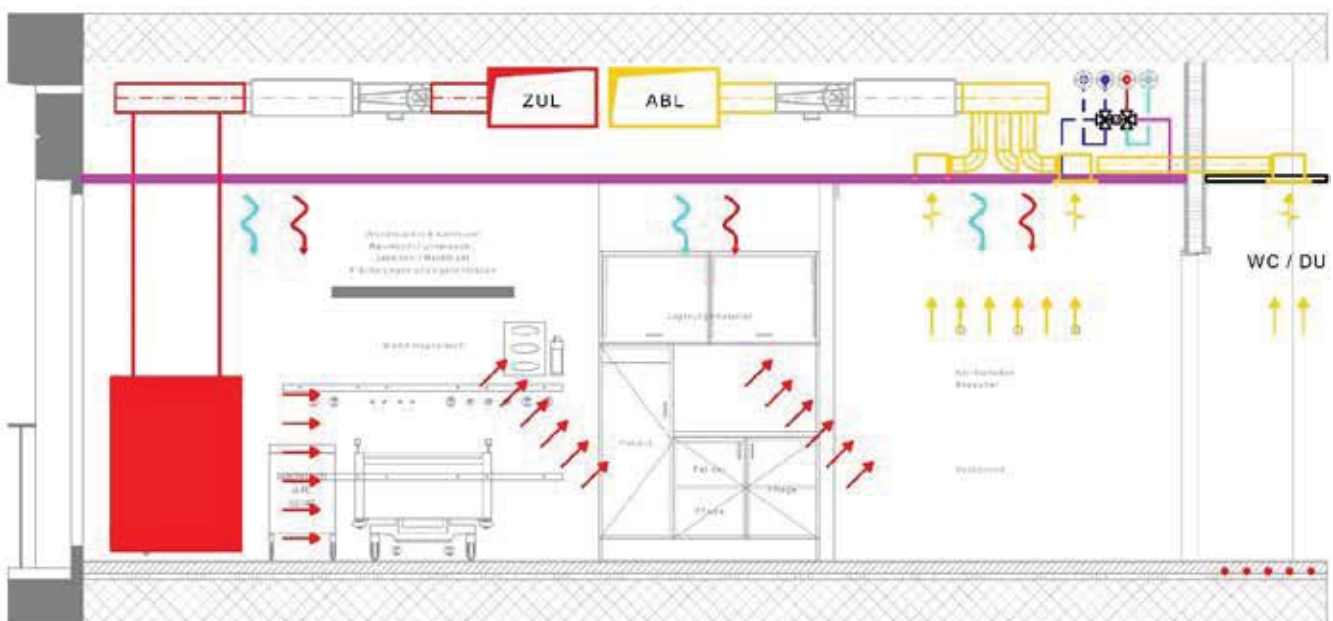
Funktionsschnitt Bettzimmer mit Heiz- / Kühldecke und Quelllüftung mit Spüllüftung
